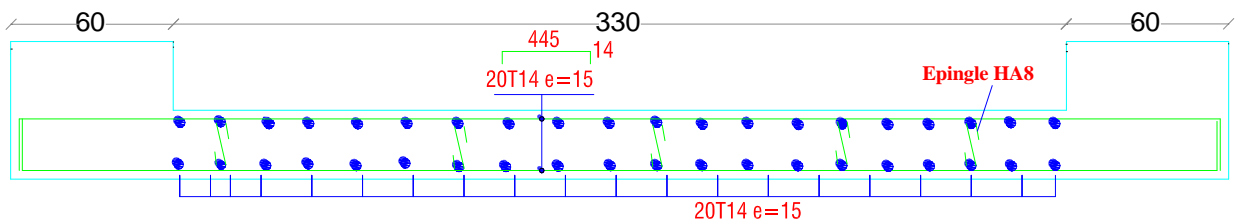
Coupe horizontale de Ferraillage des voiles au niveau de RDC.
